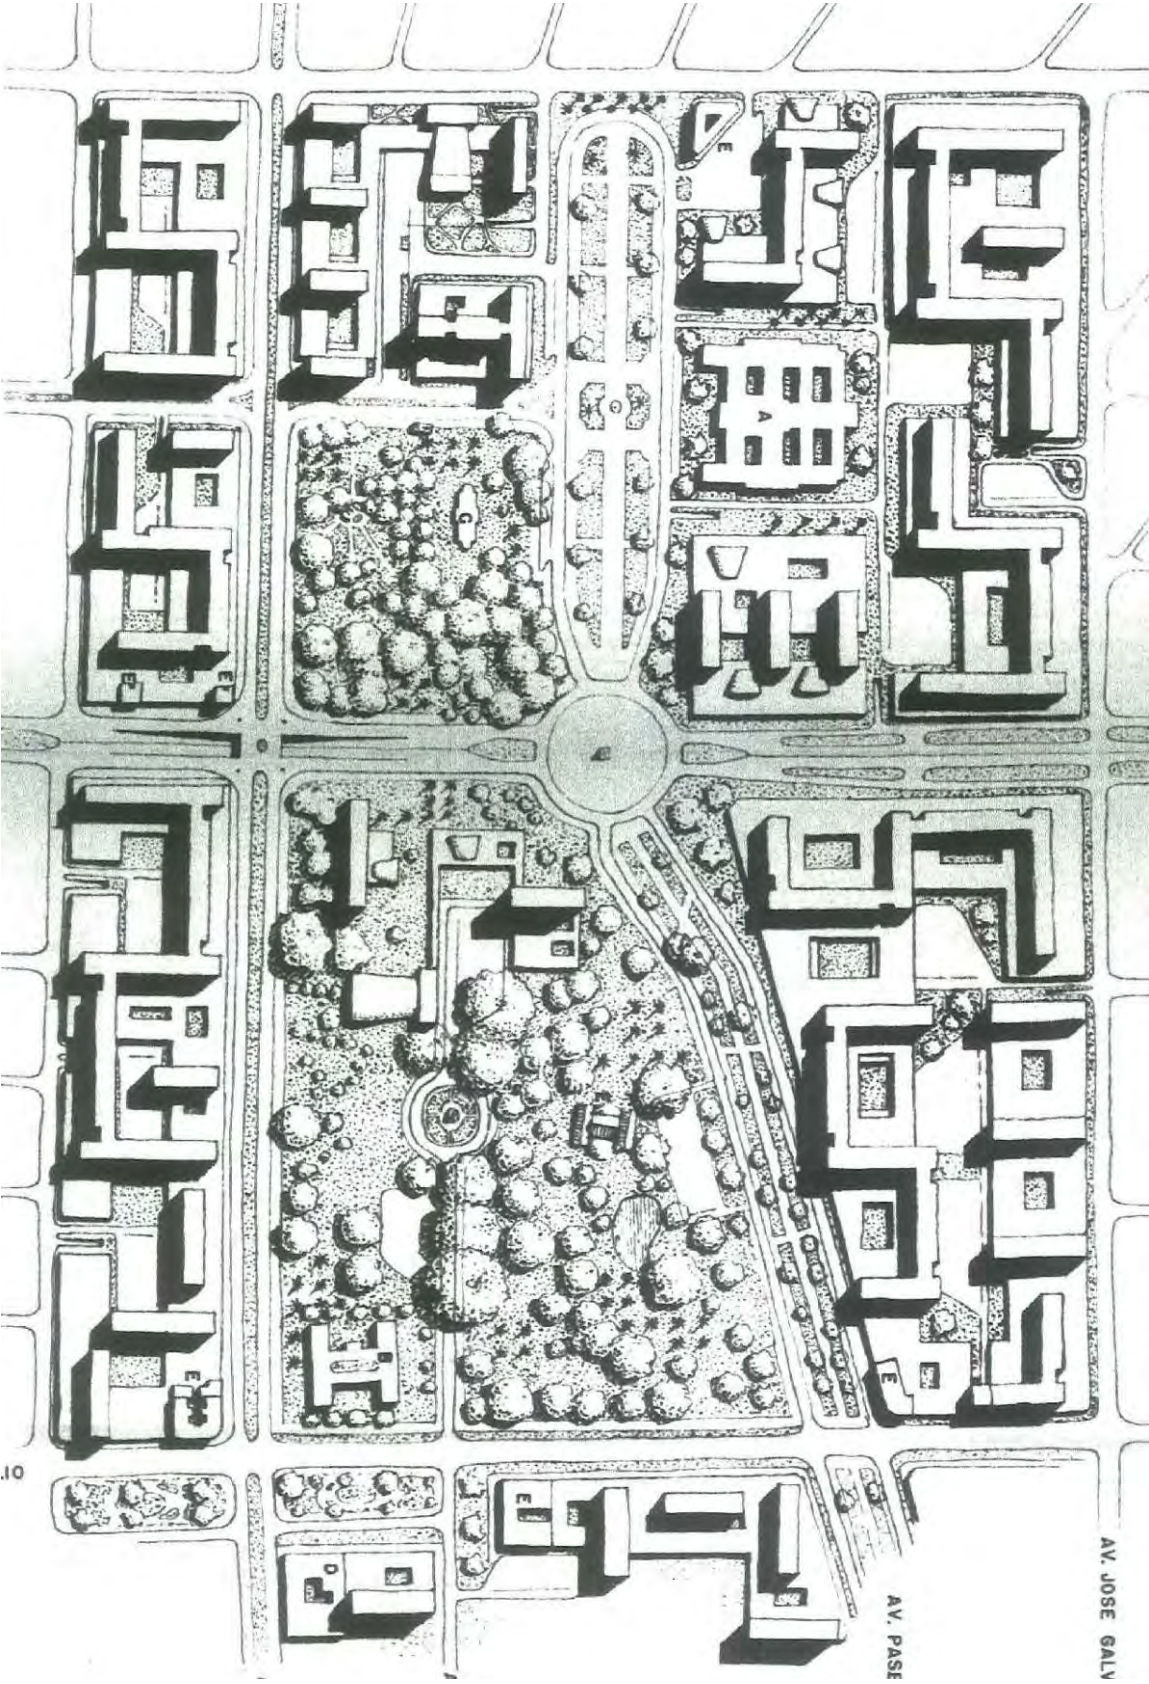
Centro Cívico. Plan Piloto de Lima.
